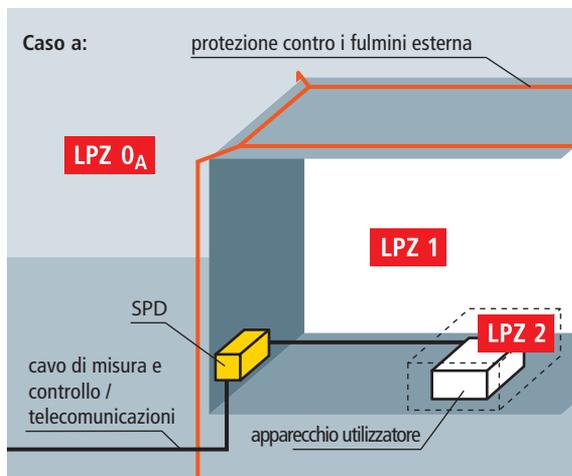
Edificio con sistema di protezione contro i fulmini esterna e linee installate all'esterno dell'edificio secondo il concetto di zona protezione contro i fulmini
